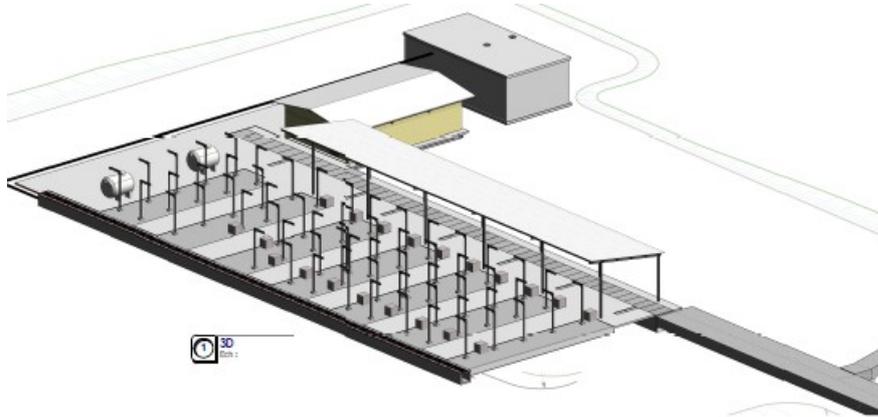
Vue 3D du stockage LH2 (plan 3827-XD-1739-0005-RDP-C)
